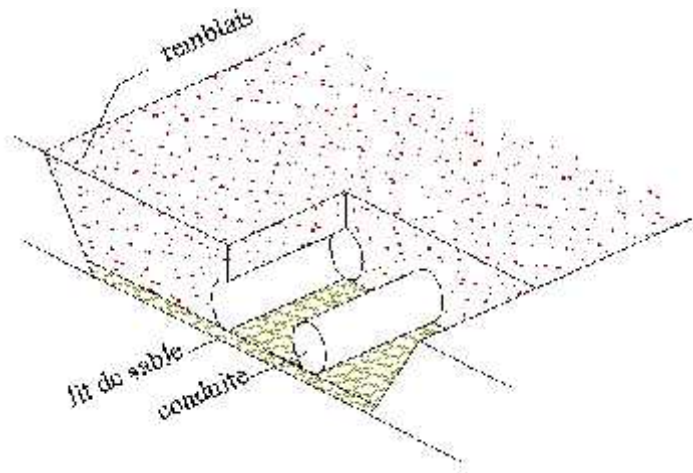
Coupe transversale d'une tranchée avec La mise en place de la conduite
